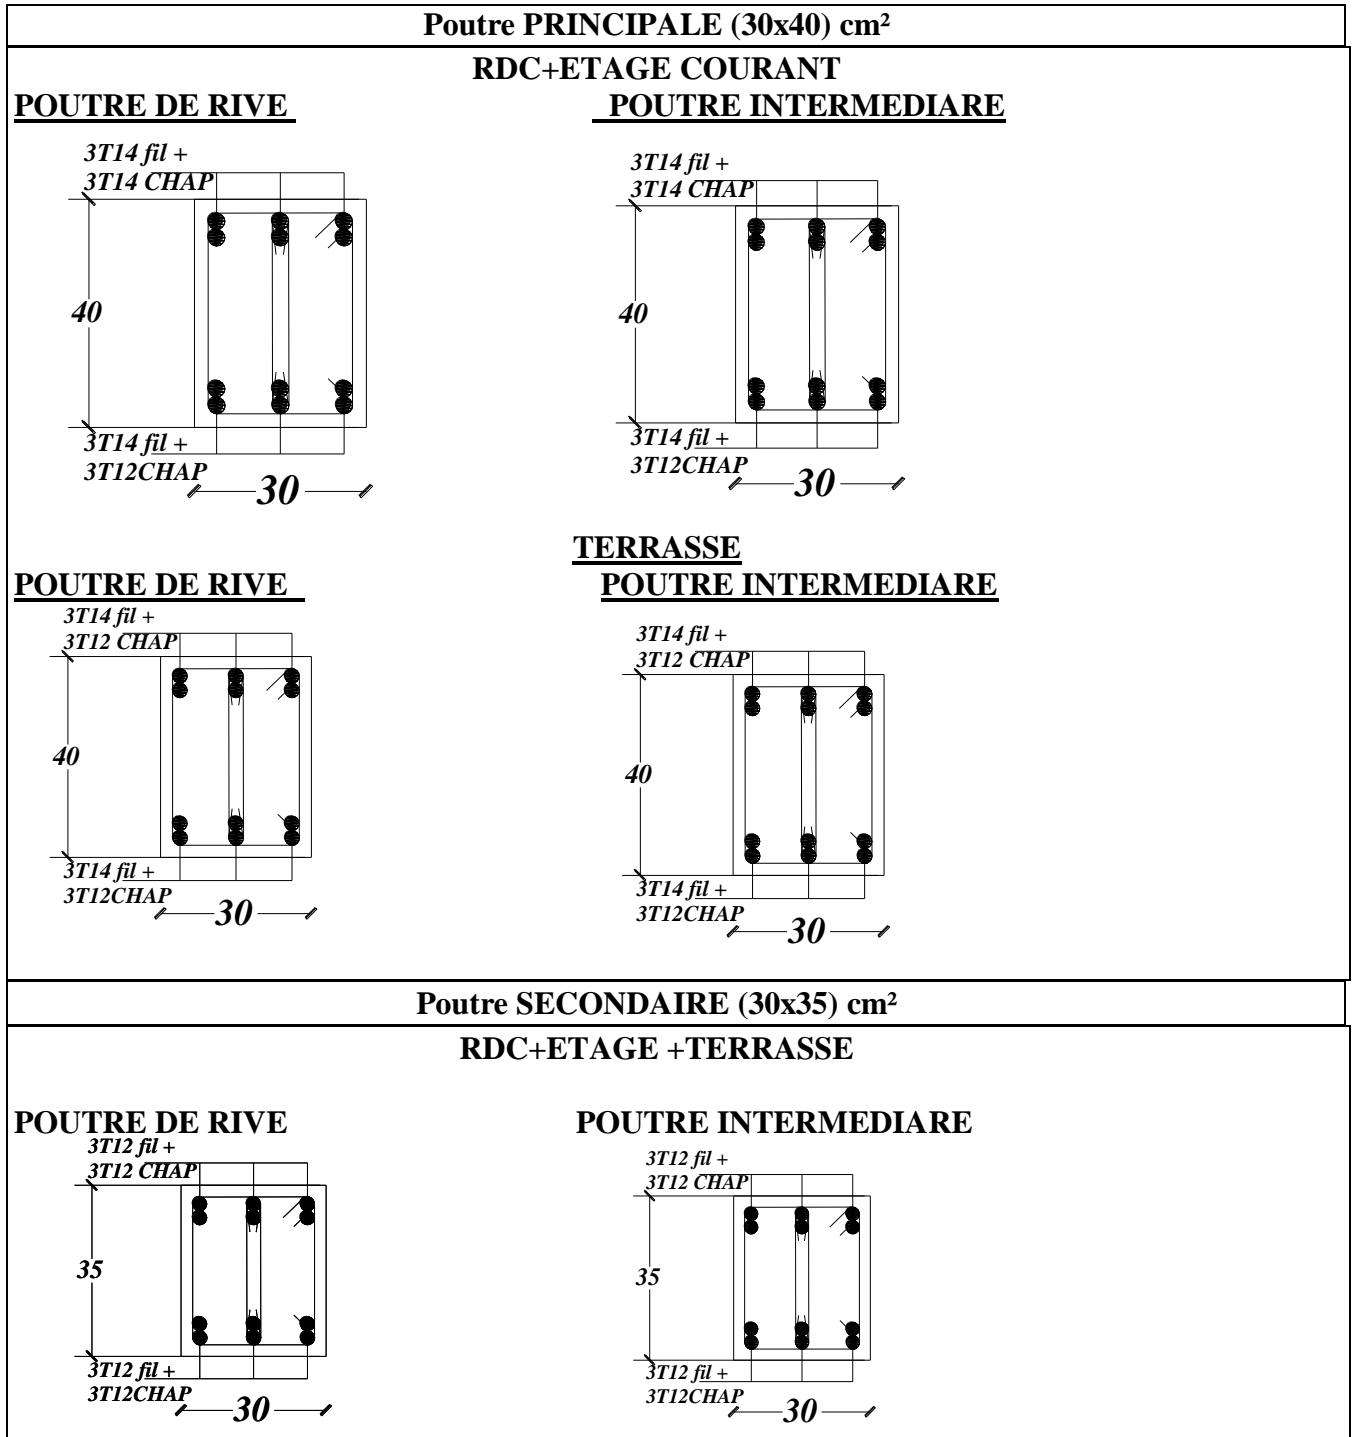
Dessin de ferrailage des sections des poutres principales et secondaires.
